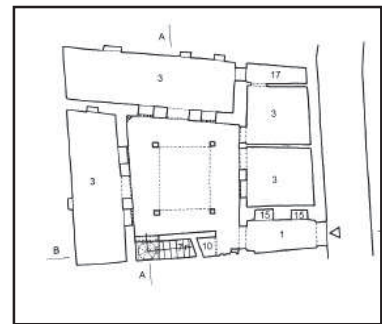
Exemple d'un plan de maison traditionnelle avec wast dar (patio)
